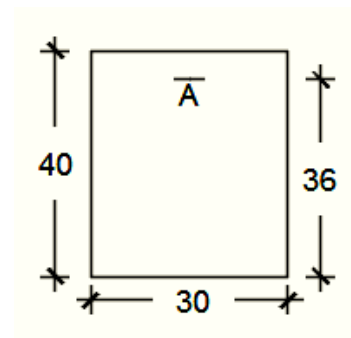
N°18 : Section de calcul de la poutre en appuis.
